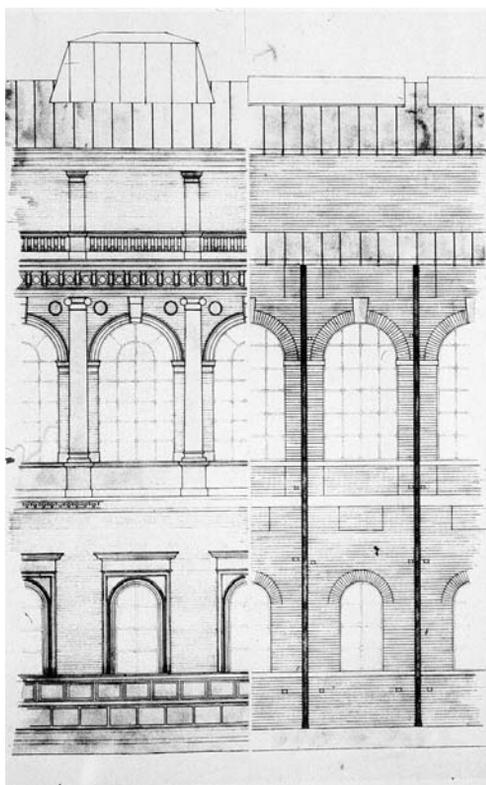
Comparativa entre el alzado original de Klenze y la propuesta de reconstrucción definitiva. Döllgast aporta el ladrillo como elemento expresivo de la fachada, en contraposición a la piedra. Este material provino del desescombros del centro. Su condición “usada” le confería un matiz cálido y envejecido que aportaba una controlada cualidad de temporalidad.
